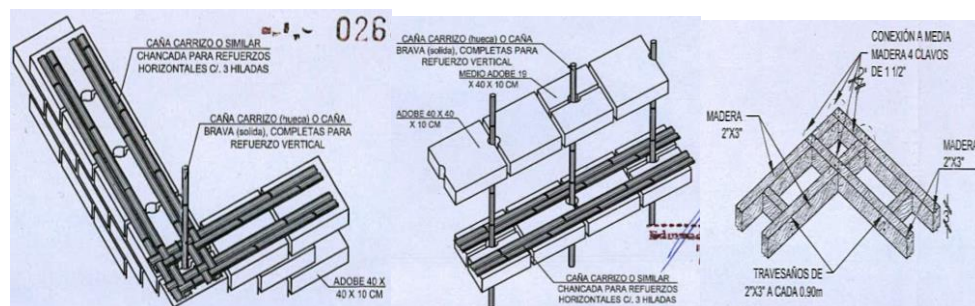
Detalle de refuerzo Horizontal y vertical en muros
